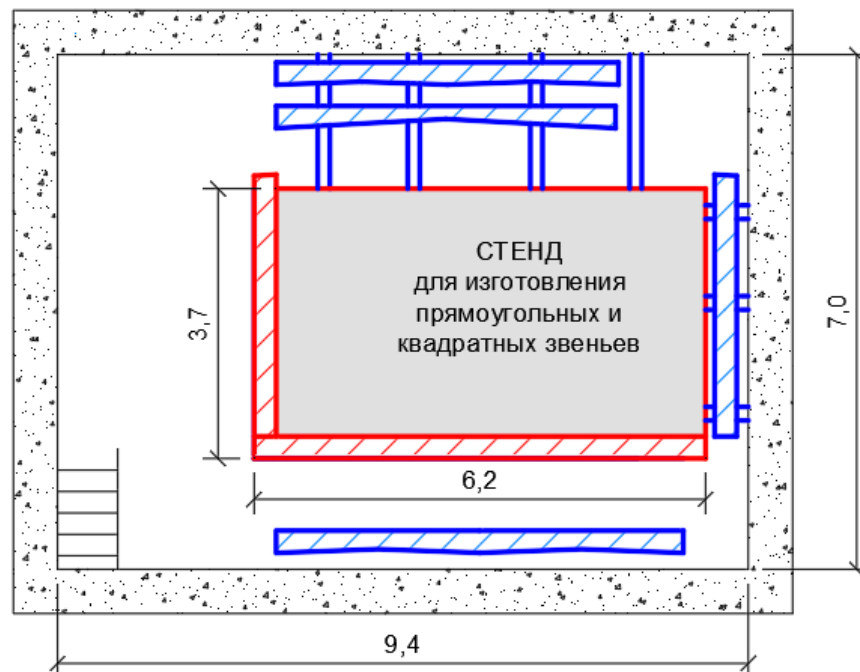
План предлагаемой камеры с размещённым в ней Стендом для изготовления железобетонных звеньев водопропускных труб квадратного и прямоугольного сечения
